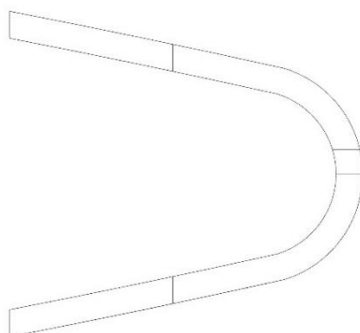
Výběr vyzkoušených půdorysů. Foto autor
